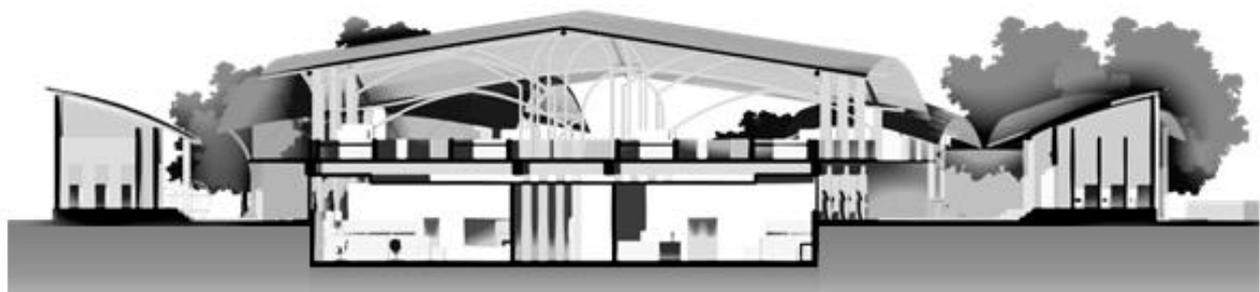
Leveling Bangunan Diturunkan Setengah Lantai
